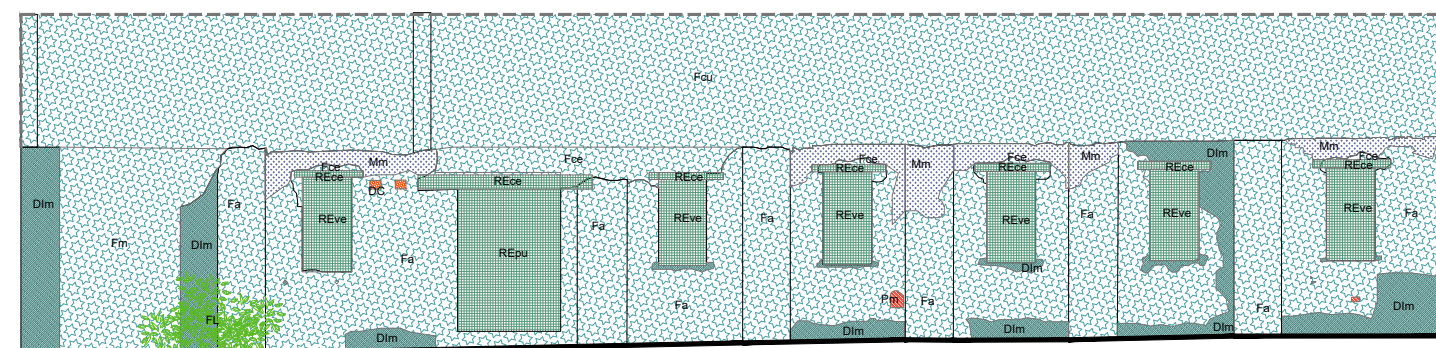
Planos de daños y deterioros en el edificio 6, en colaboración con equipo Triángulo
